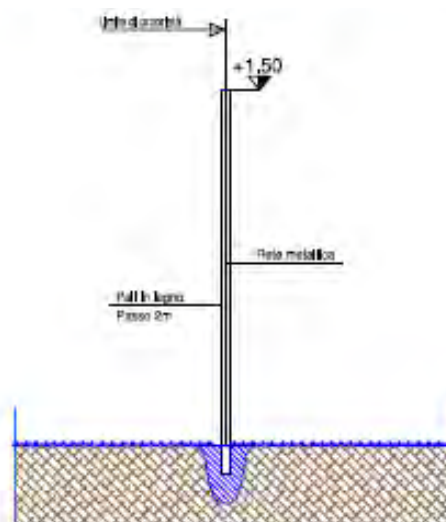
Estratto tav. di progetto - SEZIONE RECINZIONE DI PROGETTO
